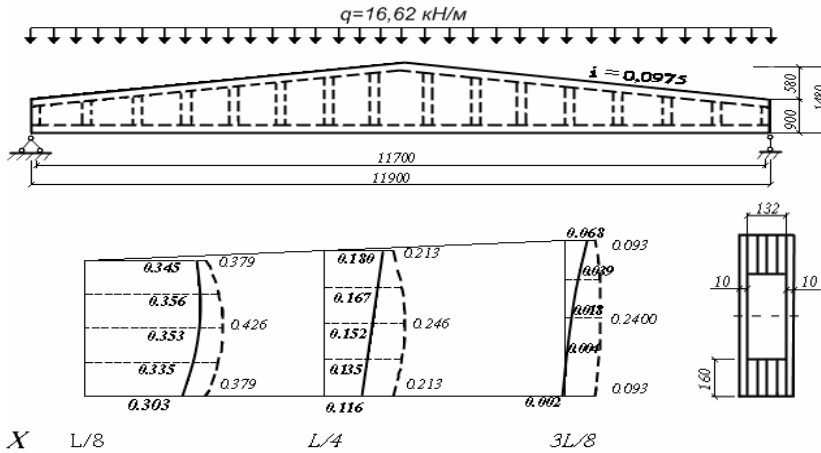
Конструкция балки и эпюры касательных напряжений по высоте стенки деревофанерной балки:
